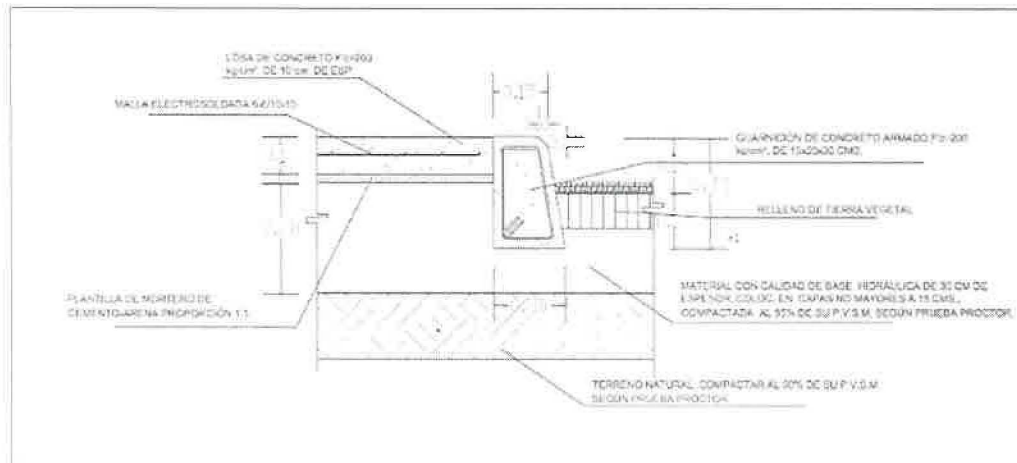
Detalle de fabricación de banqueta y guarnición trapezoidal de Concreto.
